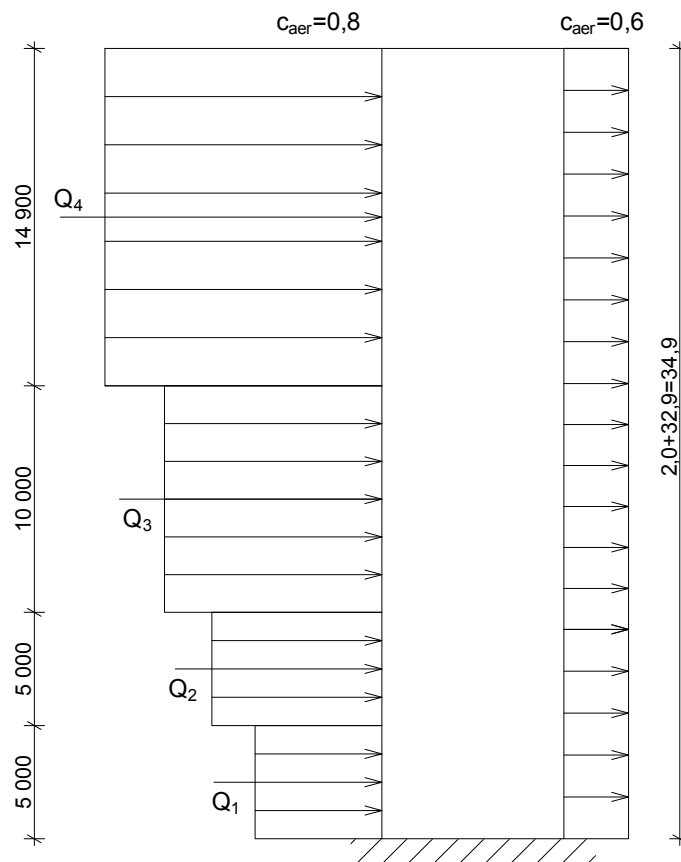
Розрахункова схема будівлі в цілому при дії вітрового навантаження
